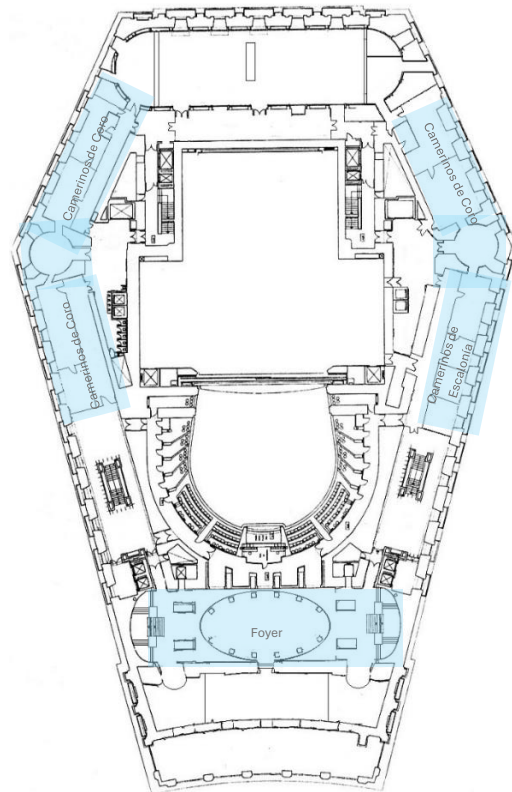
Planta 1: camerinos de coro y escalonía [13]
